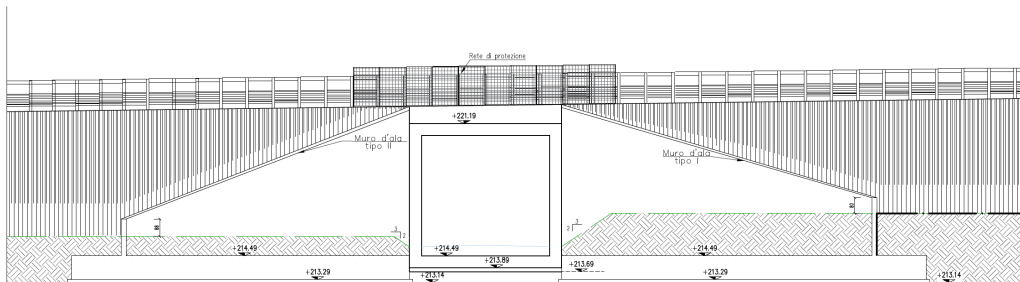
Prospetti direzione Asti e direzione Cuneo
